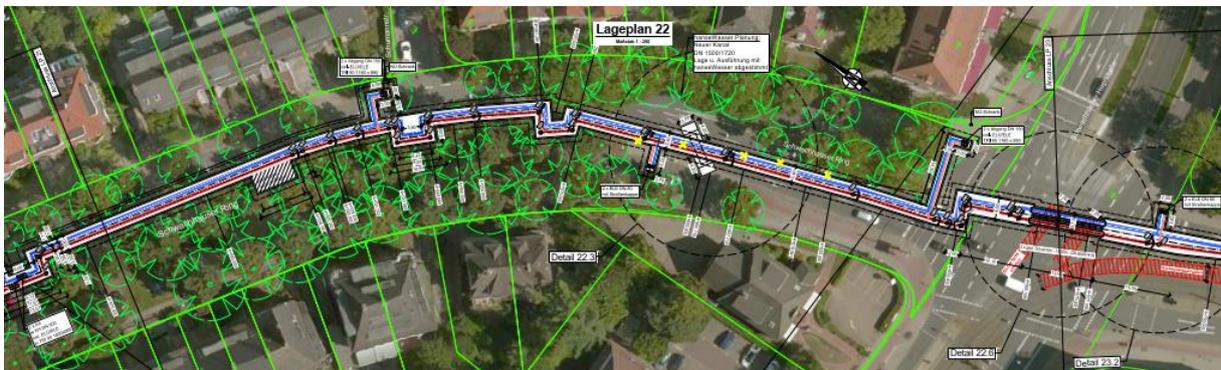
Abschnitt 12/13 - Schwachhauser Ring/Kirchbachstraße Plan 2.2.22
